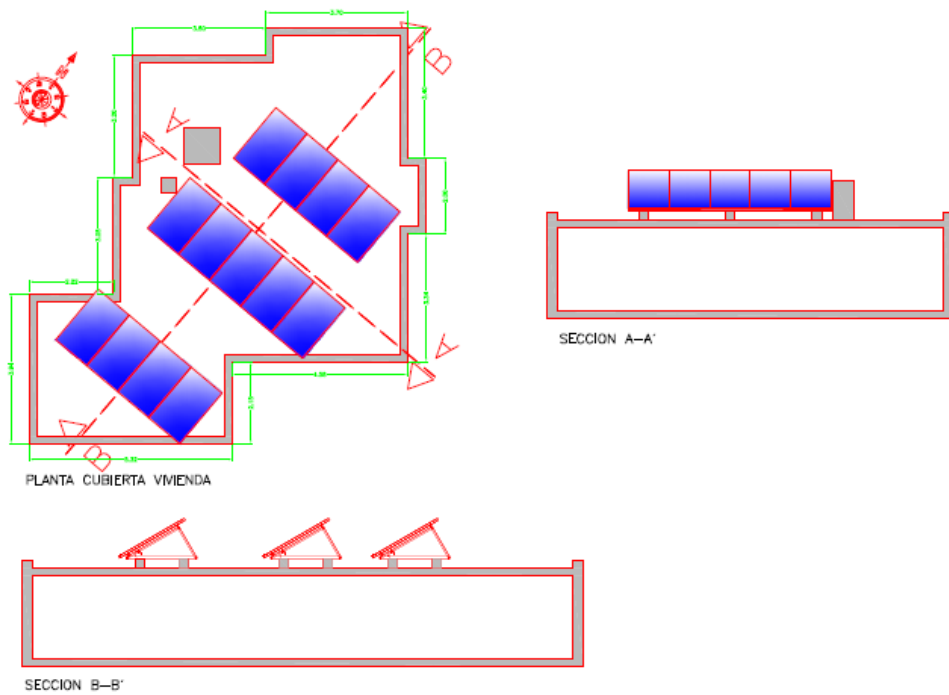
Distribución en Planta y Sección Instalación. Edificio 2
